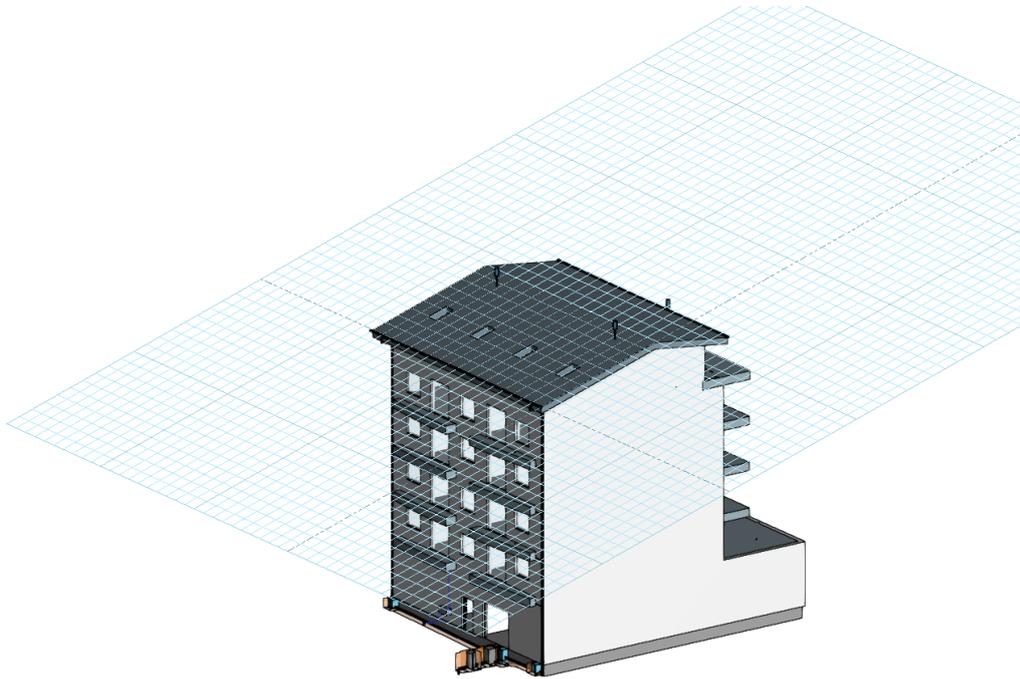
Plano de trabajo generado a partir de un plano genérico
